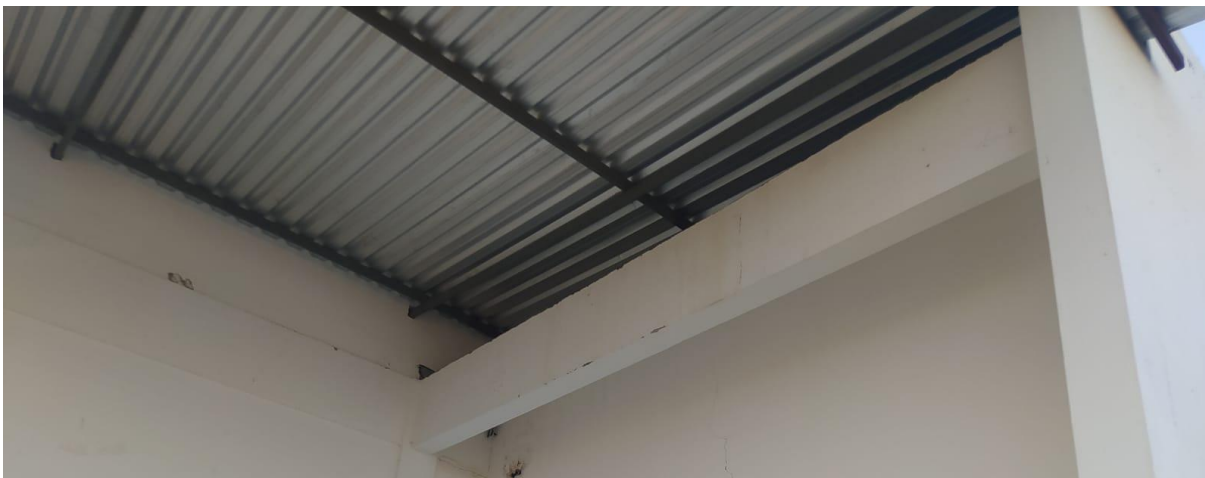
Fissura horizontal em pilar do Guarda Volume
